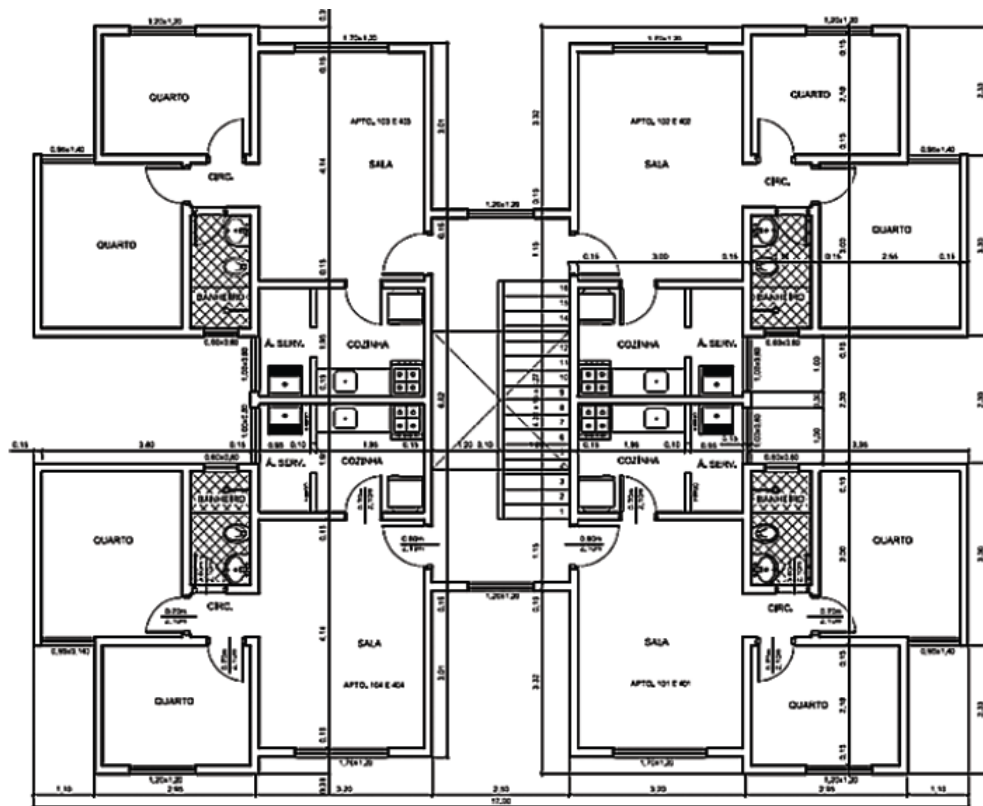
Exemplo da tipologia 4 apartamentos por pavimento
